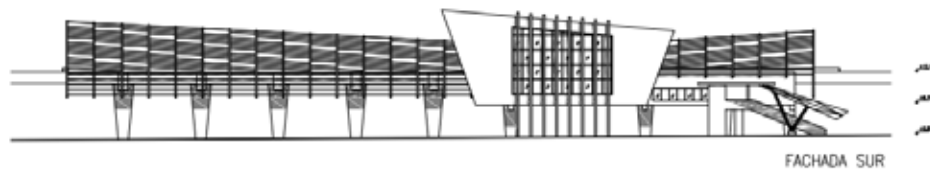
Fachada Propuesta Estación Tipo en la Ciudad de Rubio.
